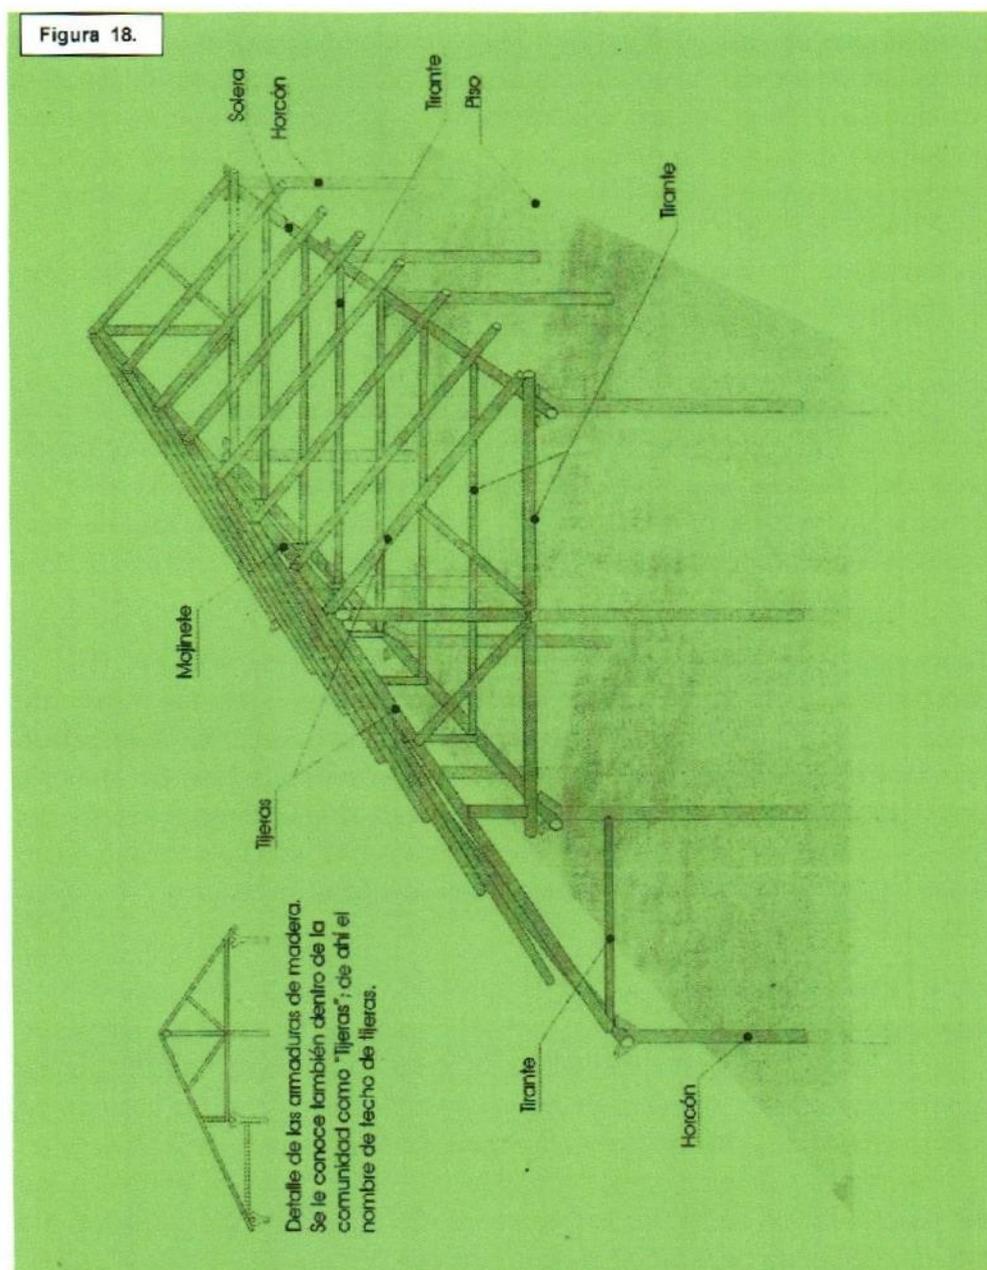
Horconadura y cubierta. Vivienda zoque.
